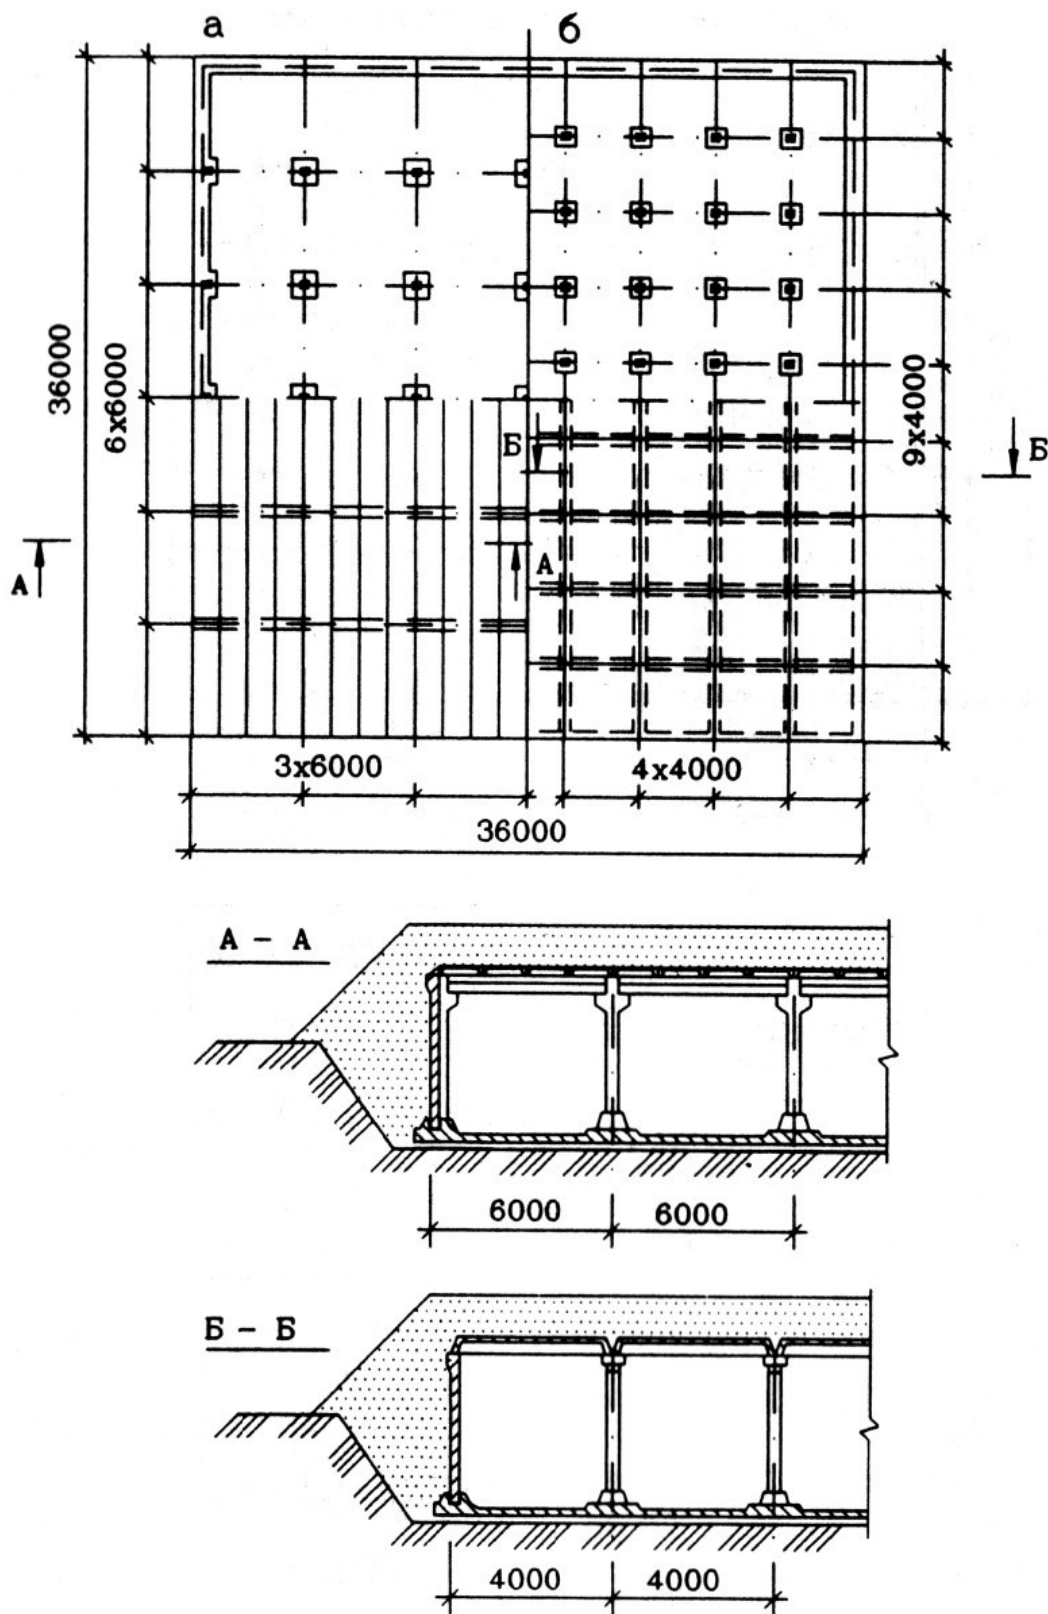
Прямоугольный сборный резервуар: а – план при варианте с плитно-балочным покрытием; б – то же с безбалочным покрытием
